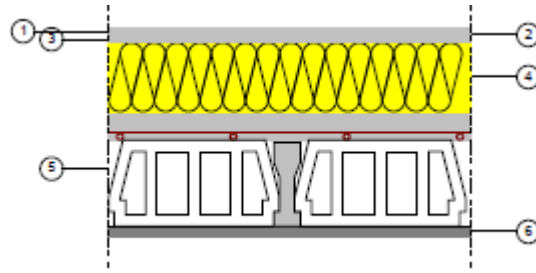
Detalle de los componentes de la cubierta tipo 2.
